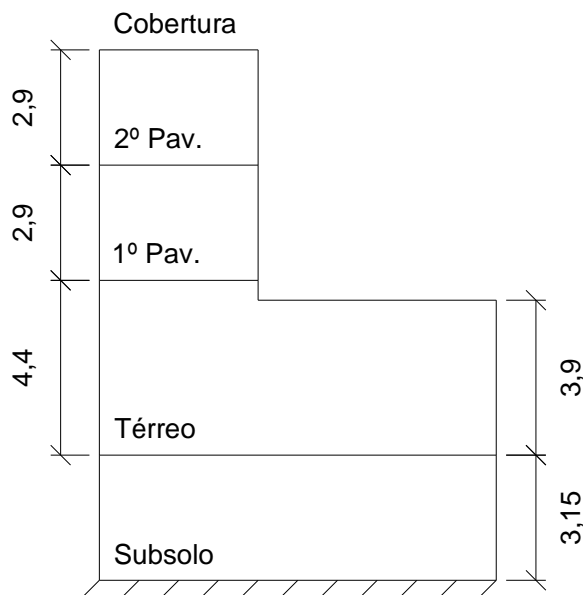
Corte transversal esquemático da estrutura ao longo do eixo x (dimensões em metros).
